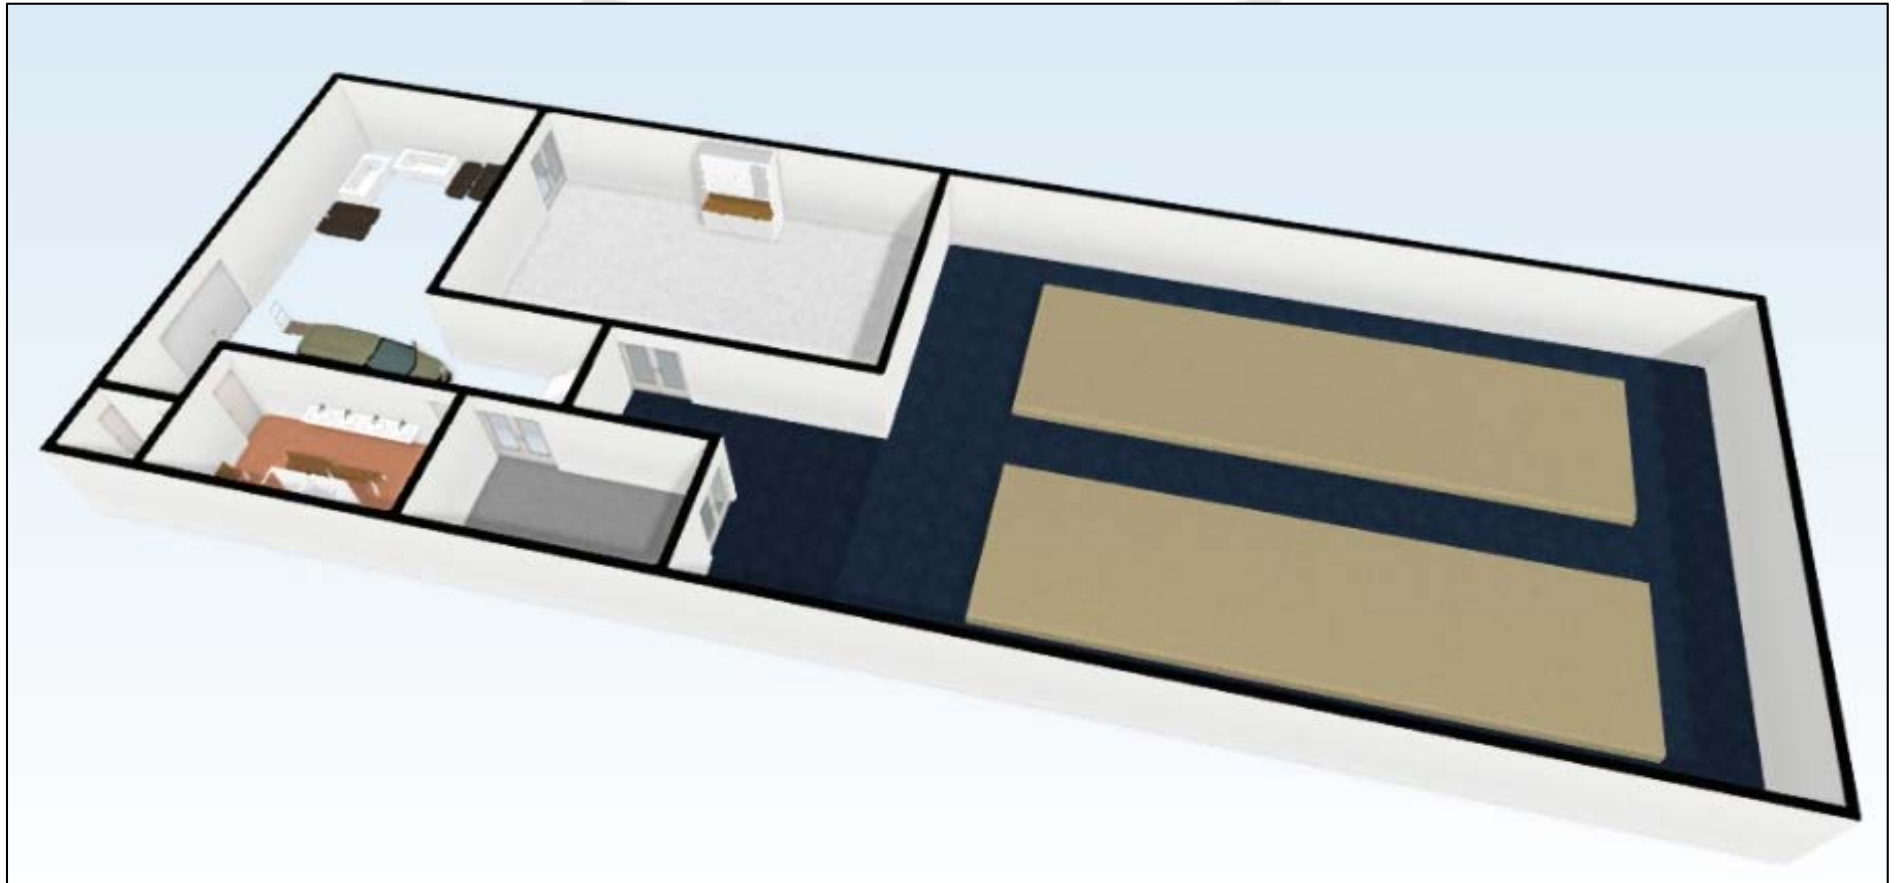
DISPOSICIÓN FÍSICA DE PLANTA – 1ER PLANO
